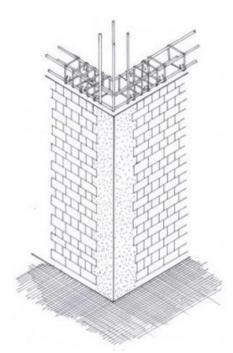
Расположение железобетонной колонны в теле кладки (рекомендации к Еврокоду 8)
